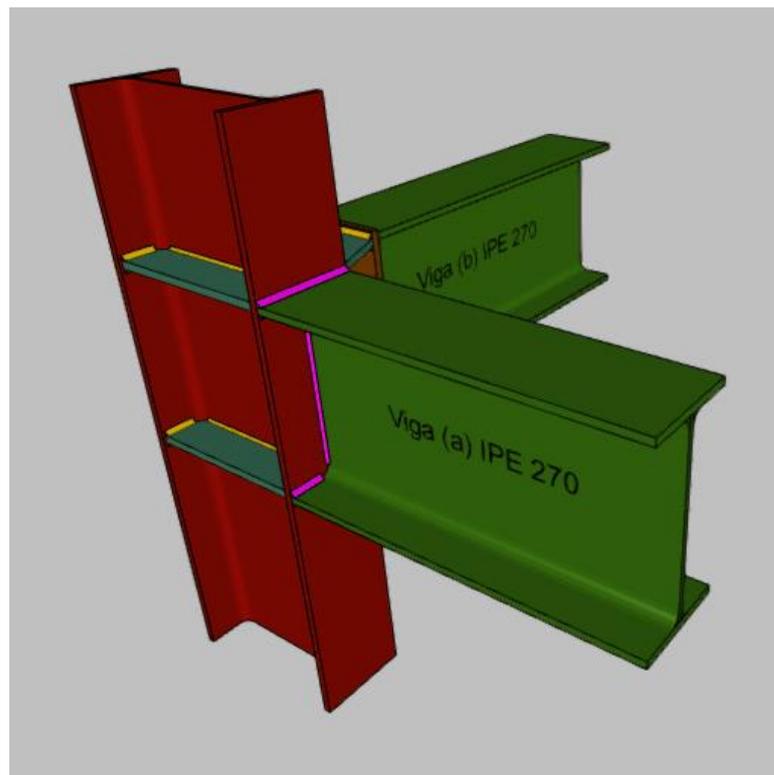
Unión pilarillo-vigas de entreplanta
